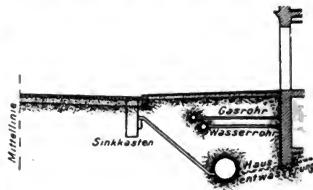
Unterbringung des Straßenkanals auf beiden Straßenseiten unter den Fußwegen.
